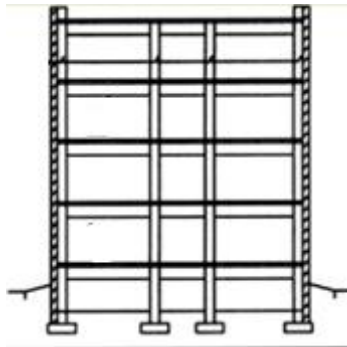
Каркасна схема багатоповерхової будівлі[2]
